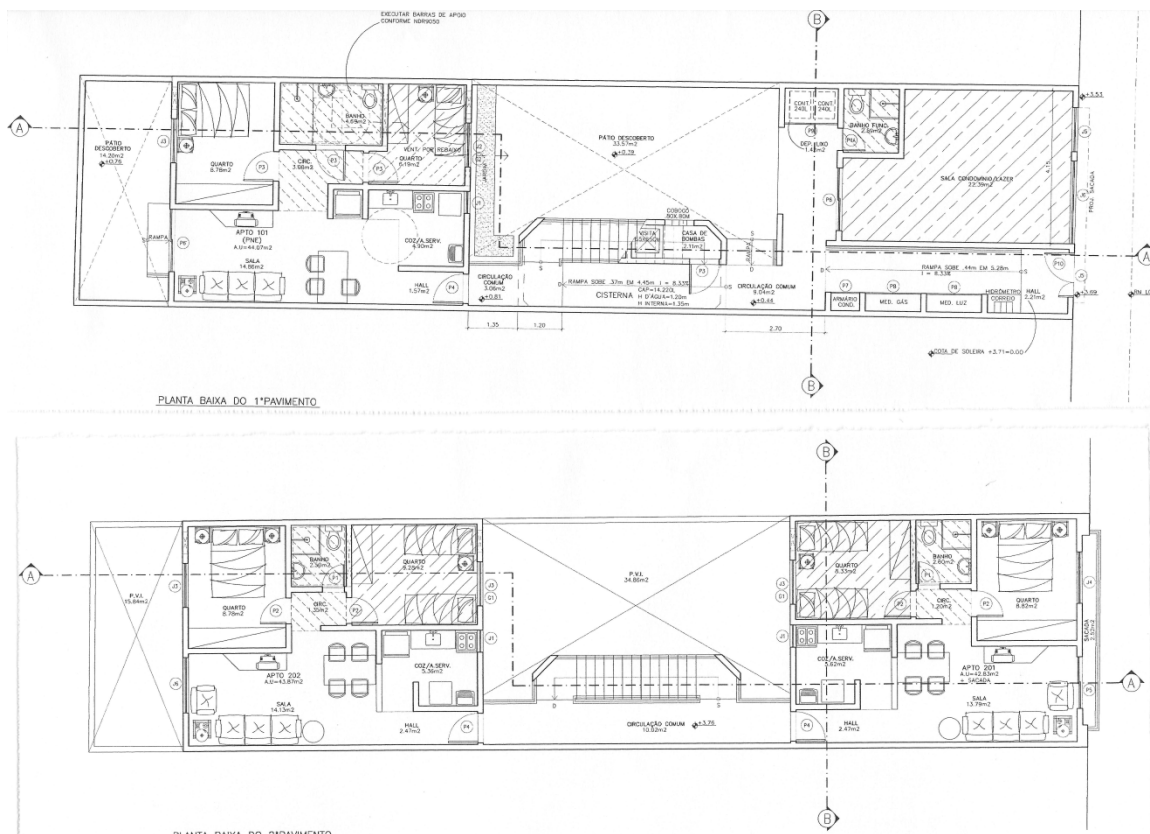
Planta de layout do 1º e 2º pavimento do empreendimento João Álvares 16.
